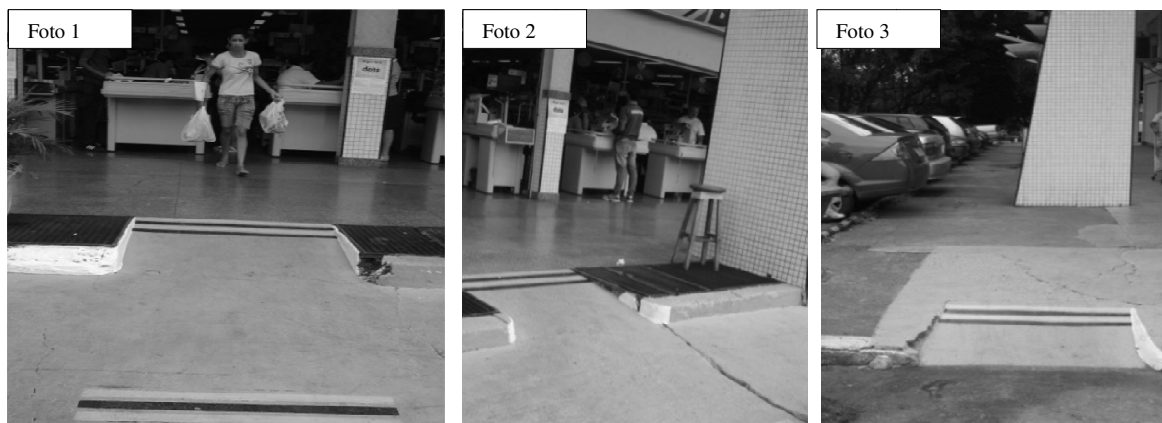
Foto 1, Rampa 106NDR1; Foto 2, Rampa 106NDR2; Foto 3, Rampa 106NDR3
